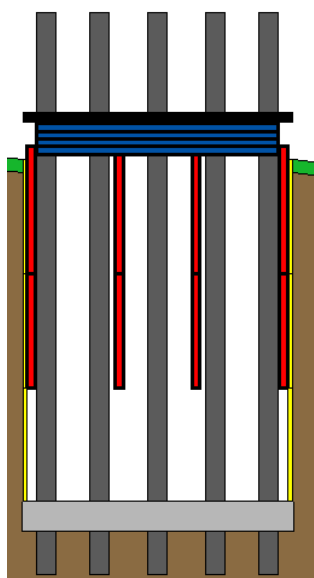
Бетонирование конструкций стен захватки 2
